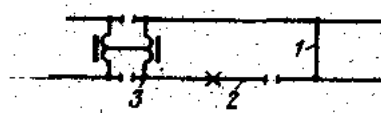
Схема установки поперечной обходной перемычки при замене рельса у изолирующего стыка:
